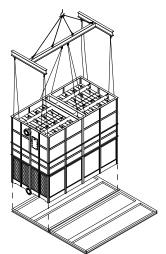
Levantamiento e instalación de la sección M1A de una torre RTGMTC.
